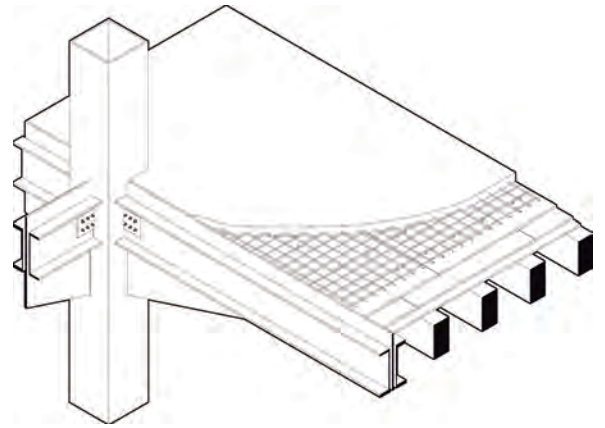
Detalle de la discontinuidad de la losa de concreto y la malla electrosoldada para generar juntas por dilatación por medio del diseño de las vigas principales armadas, en este caso por dos perfiles "CE" y una Placa de igual espesor del alma de los perfiles anteriores.
